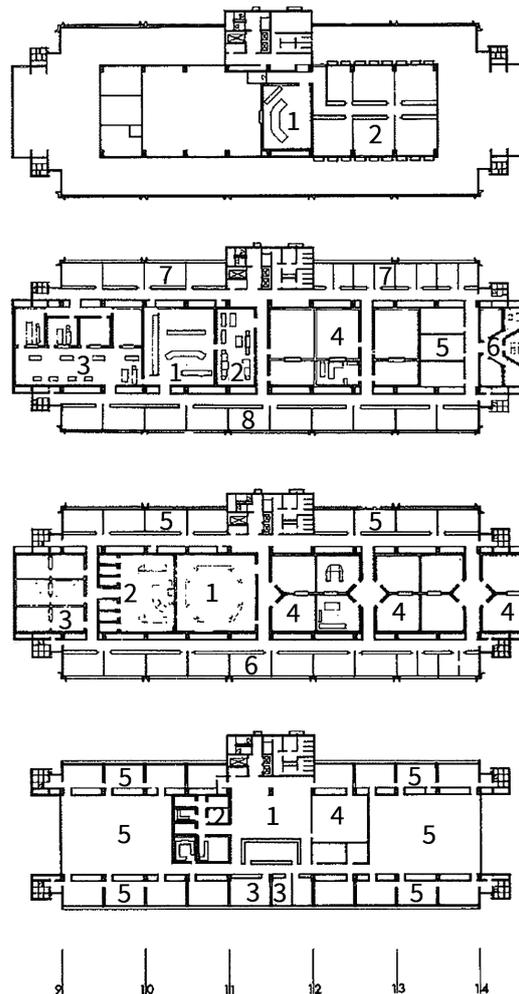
Rundfunkgebäude, Grundrisse, 5.- 8. OG, 1983
